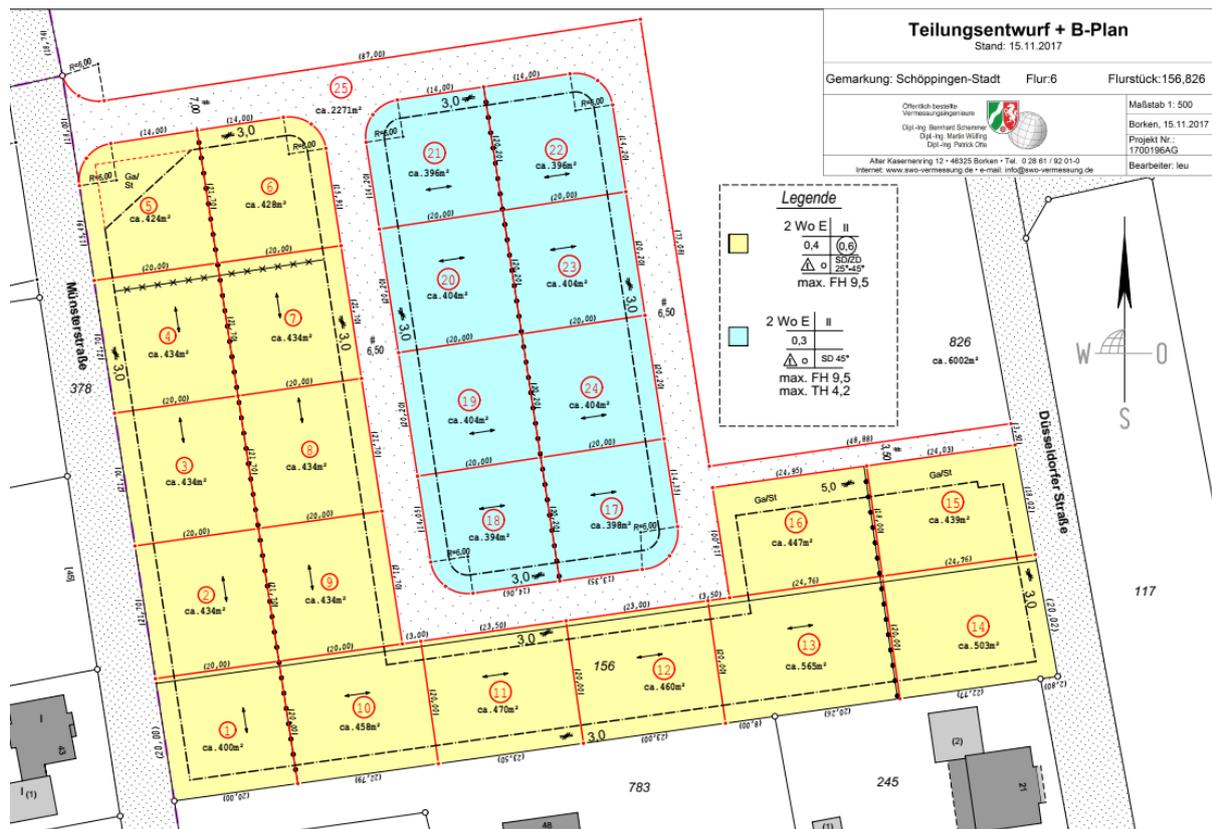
Lageplan Neubaugebiet "Am Überweg"
